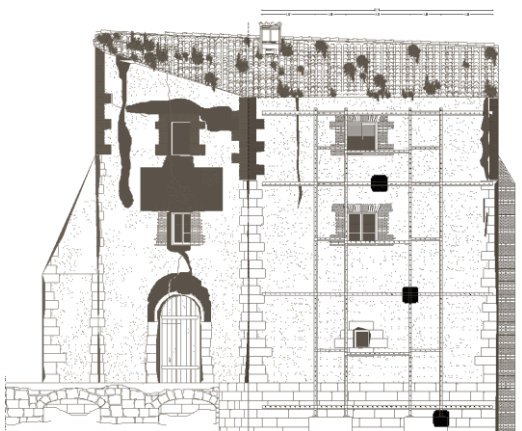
Replanteo de los estabilizadores en una de las fachadas de la fábrica de harinas.
